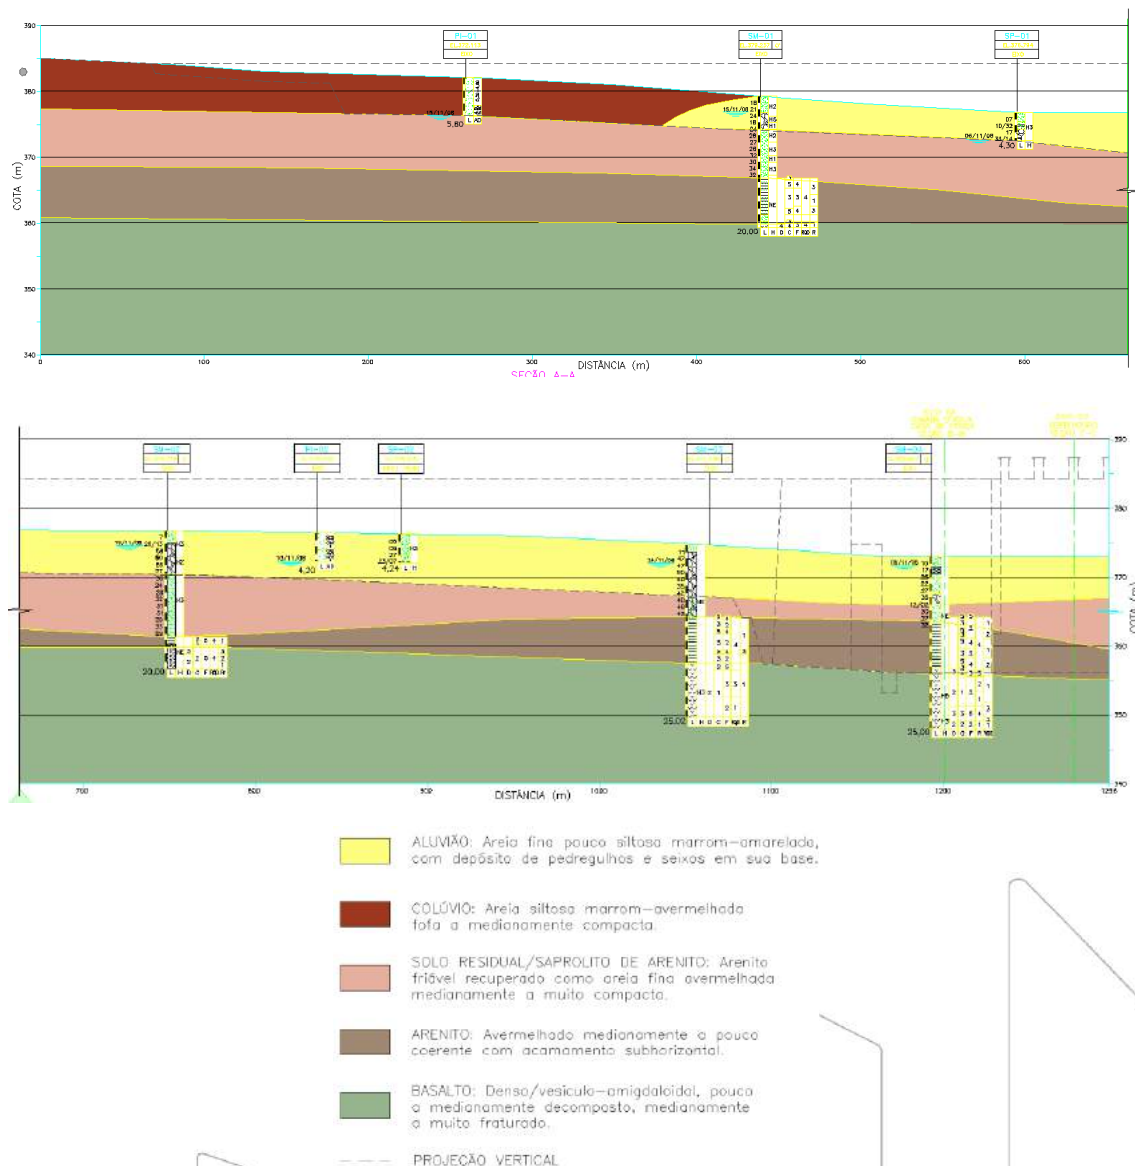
Seção típica de escavação por litologia geológica, demonstrado o perfil geológico.
